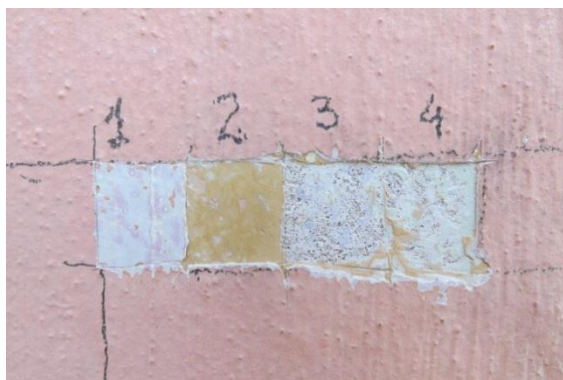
Detalhe das camadas encontradas na fachada frontal.
